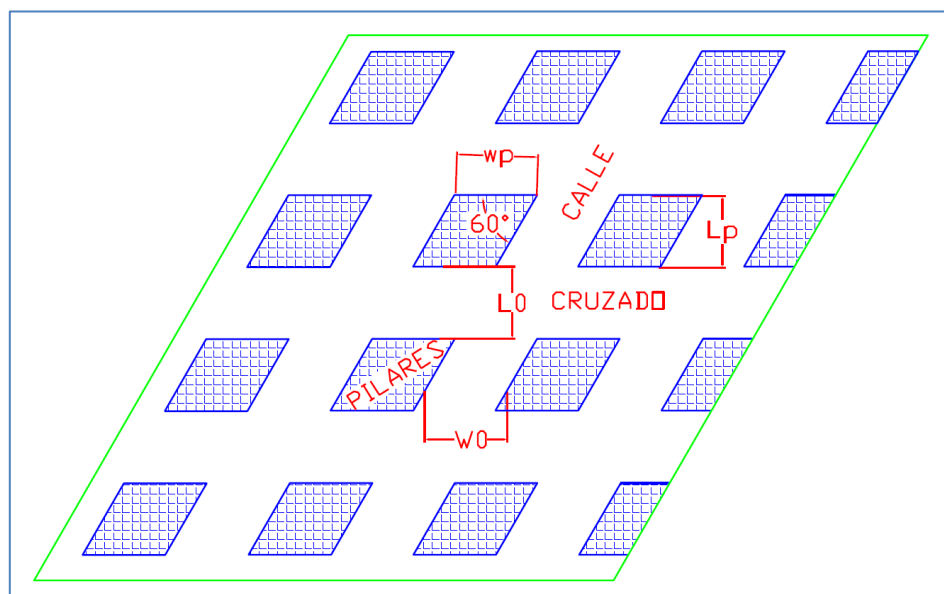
Disposición en planta y parámetros de diseño Room and Pillar
